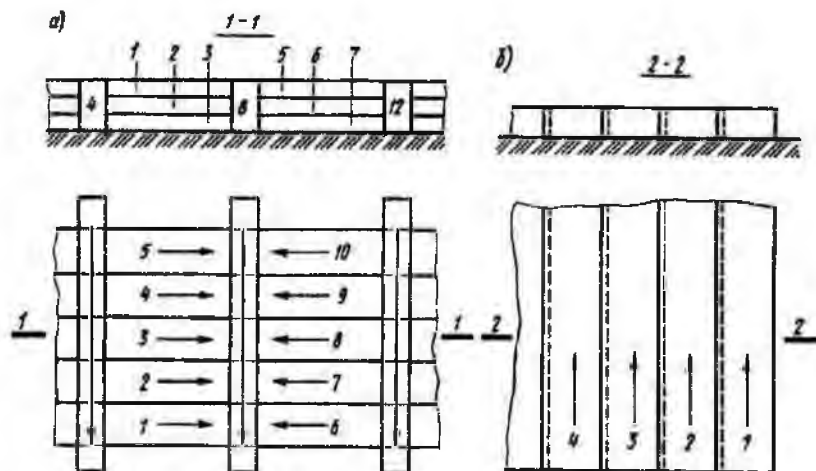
Схема разработки грунта бульдозером: а — траншейным разрезом; б — послойным; 1, 2, 3, ... — последовательность разреза
